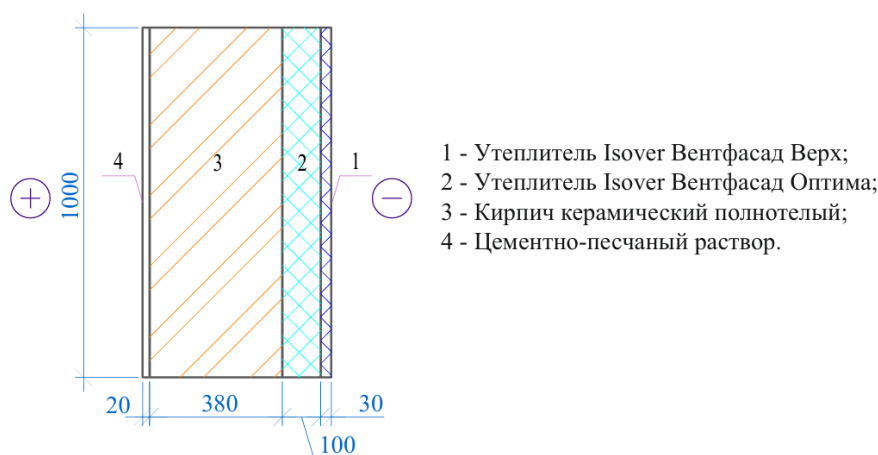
Схема стены с утеплением минеральной ватой в два слоя
